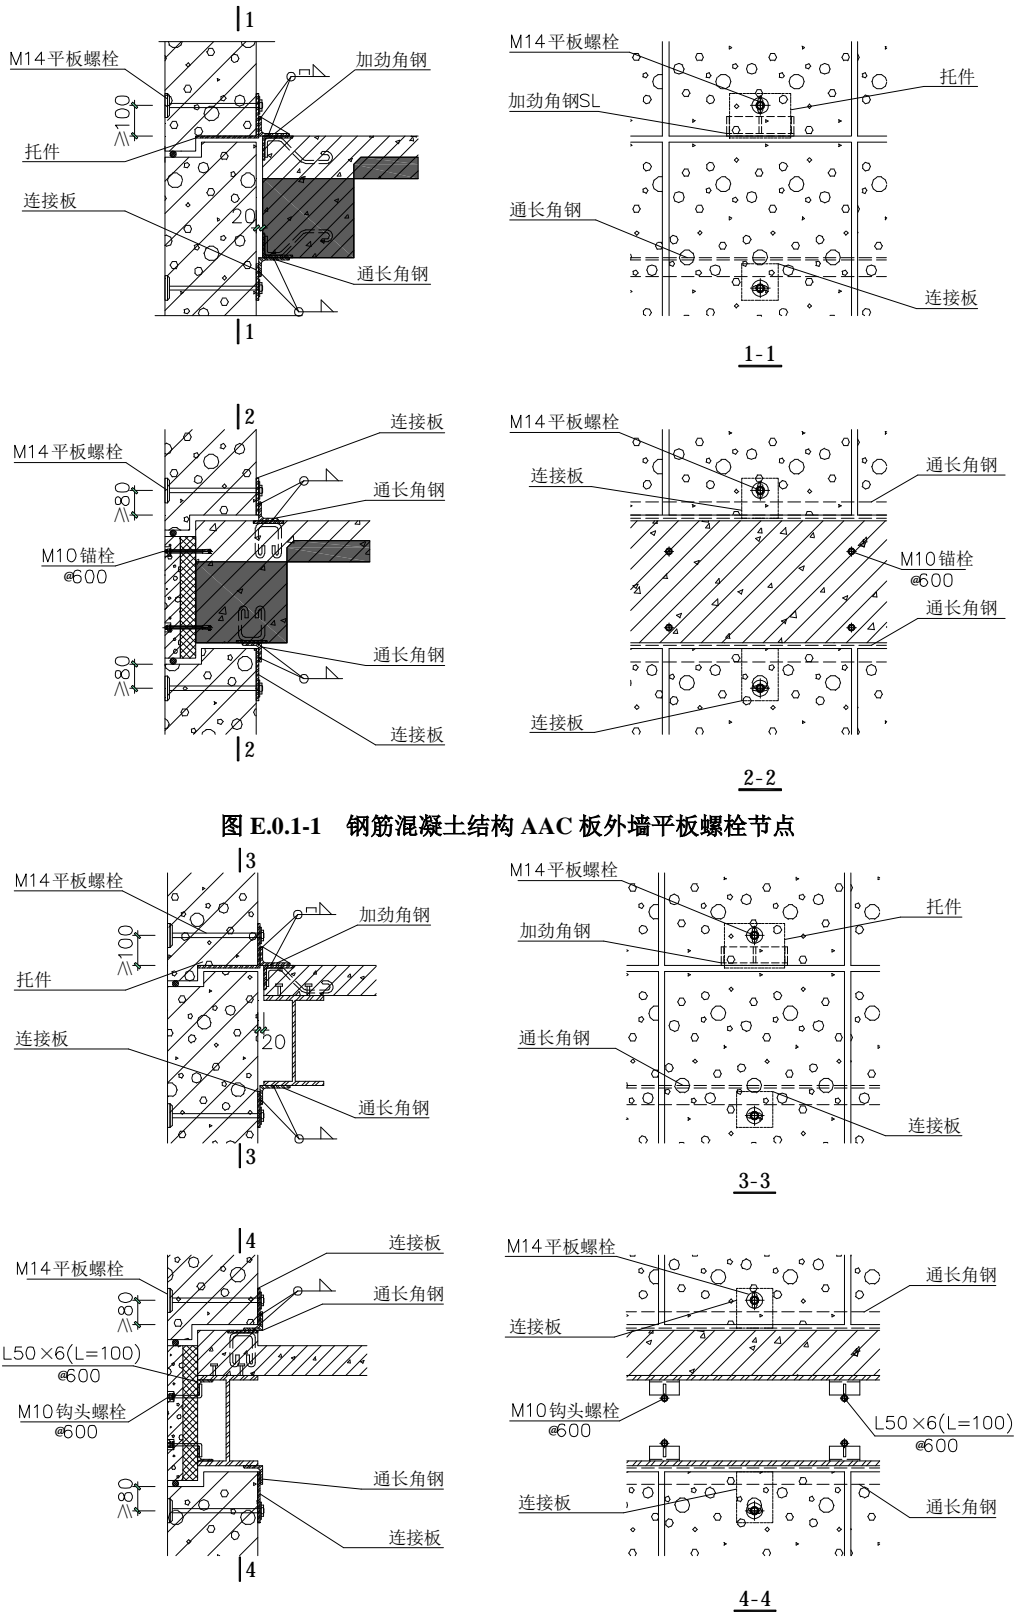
钢筋混凝土结构 AAC 板外墙平板螺栓节点
